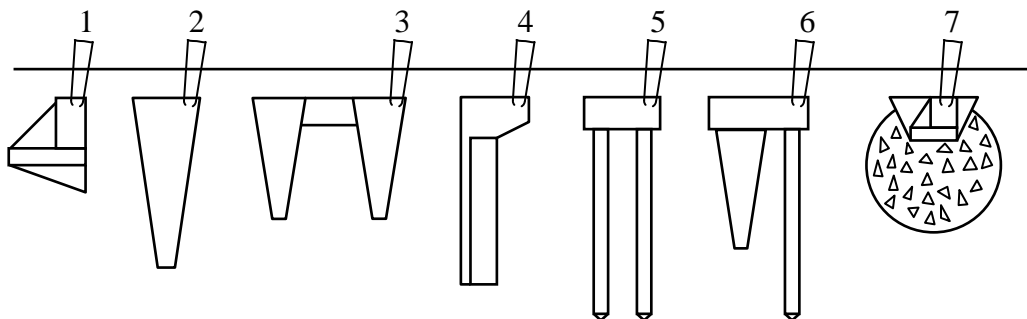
Фундаменти під стояки несучих розпірних конструкцій:
